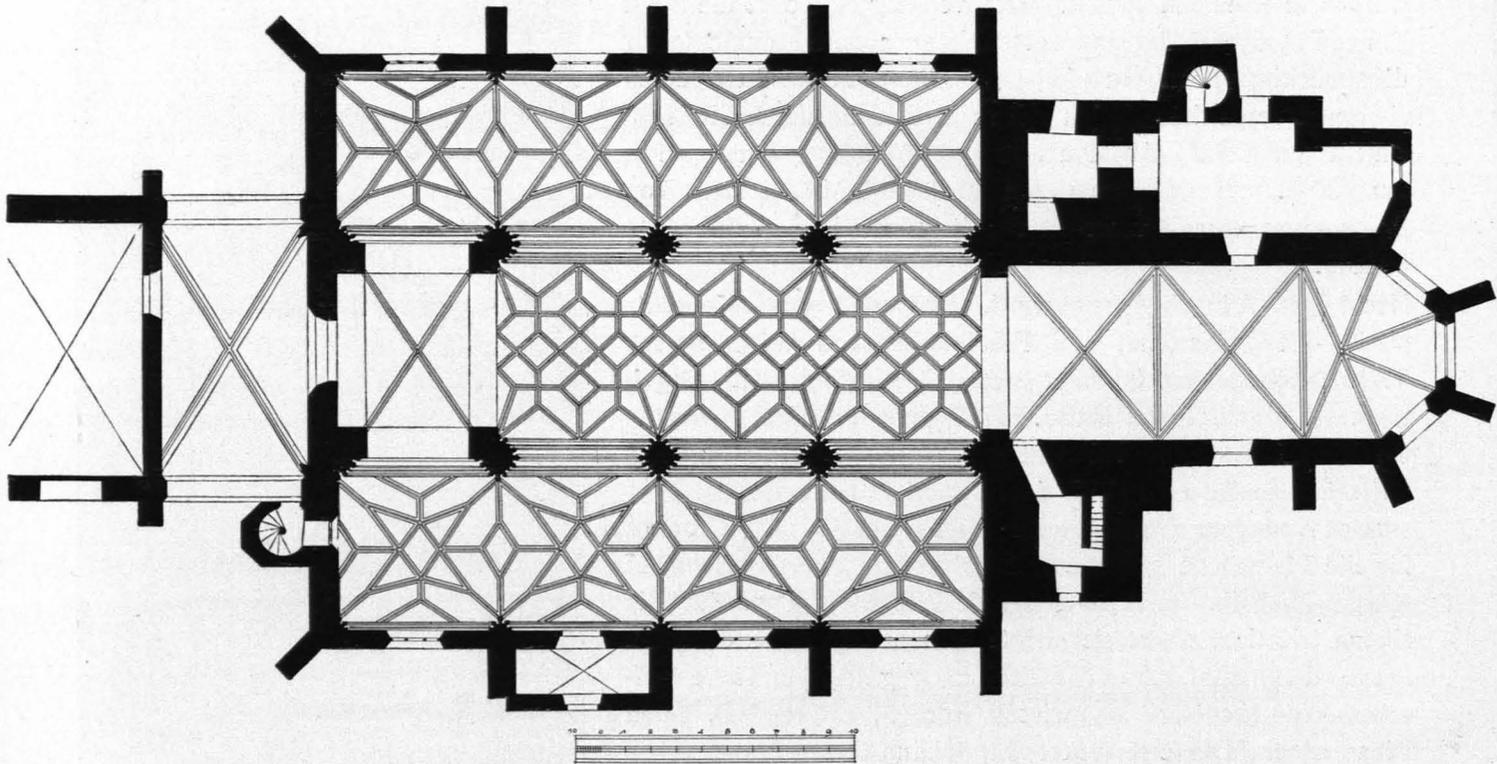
Eggenburg, Pfarrkirche, Grundriß 1:300 (S. 26)
